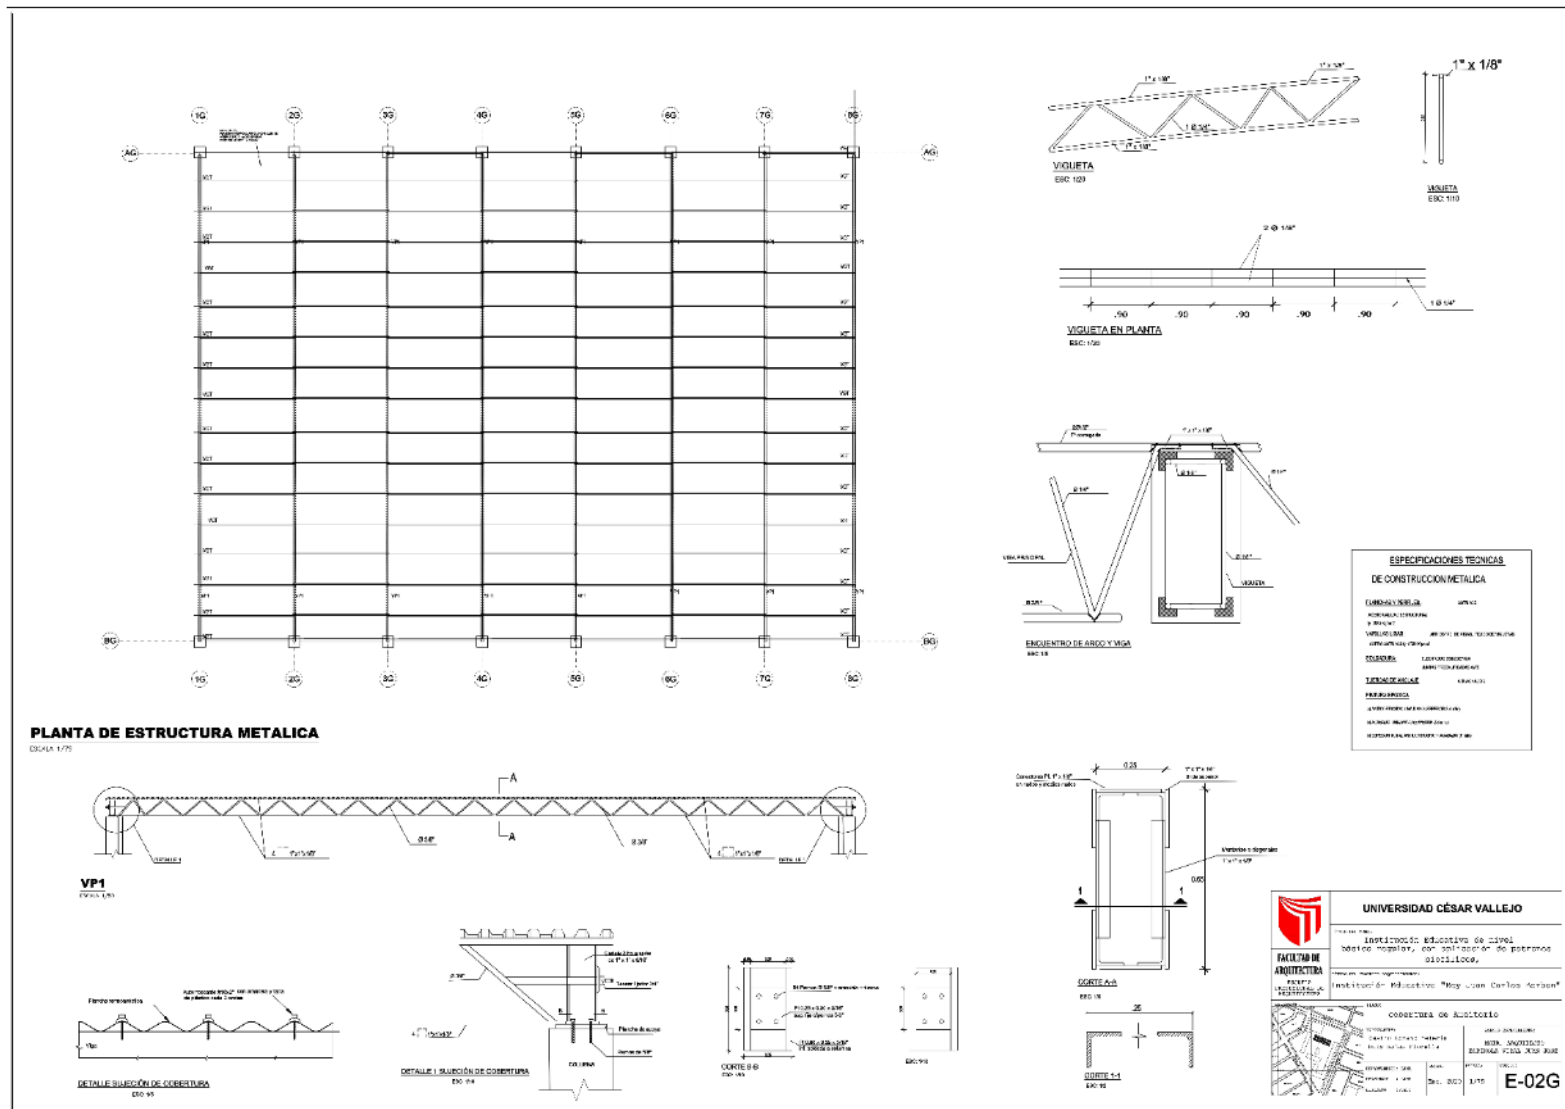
Plano estructural de cobertura metalica bloque "G", Fuente: elaboración propia
